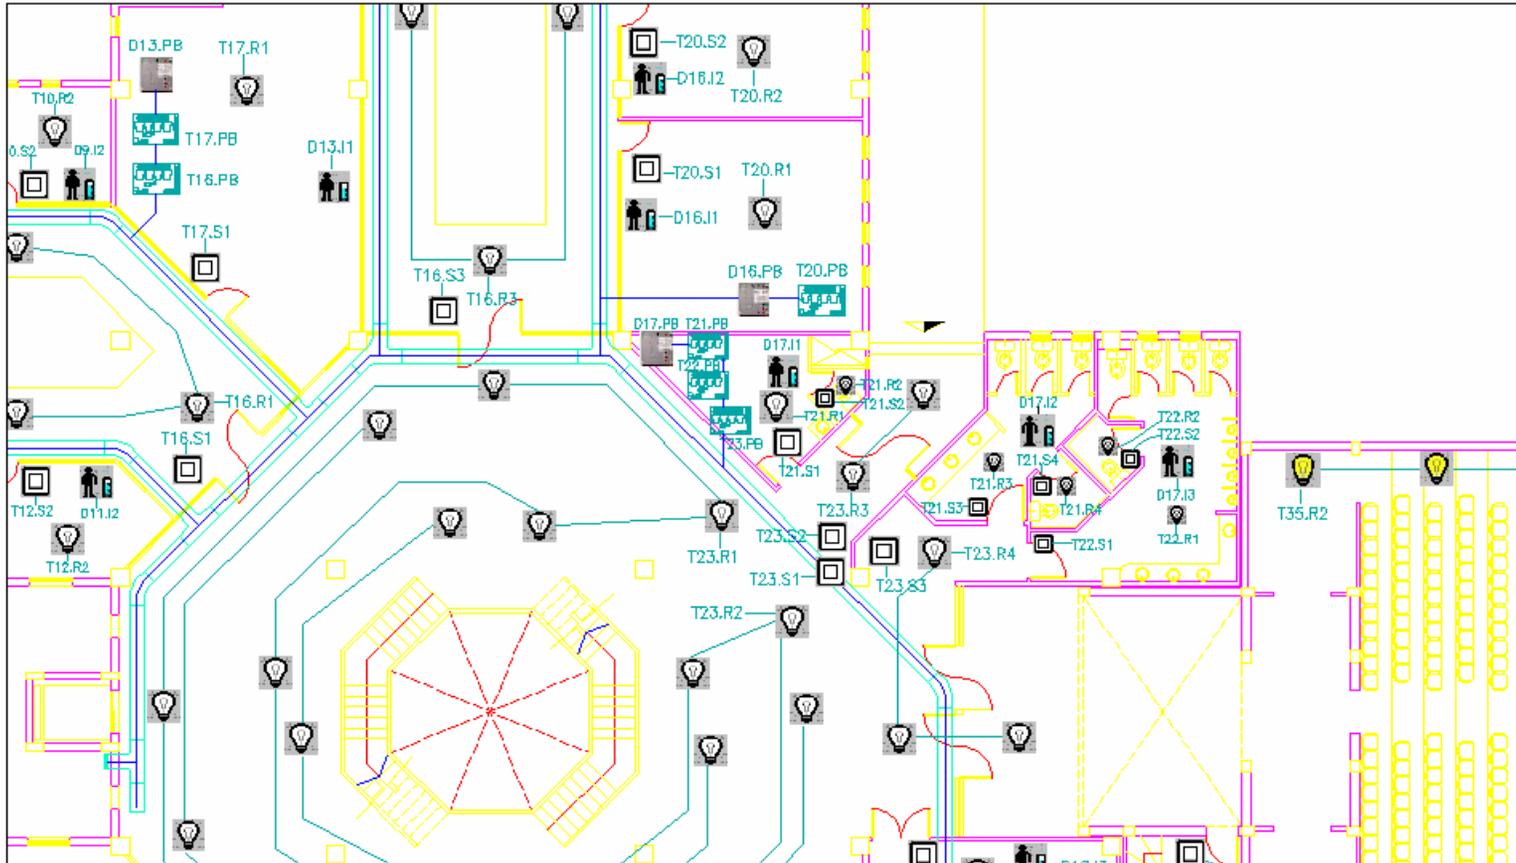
PLANO ILUMINACION PLANTA BAJA SECCION 5
